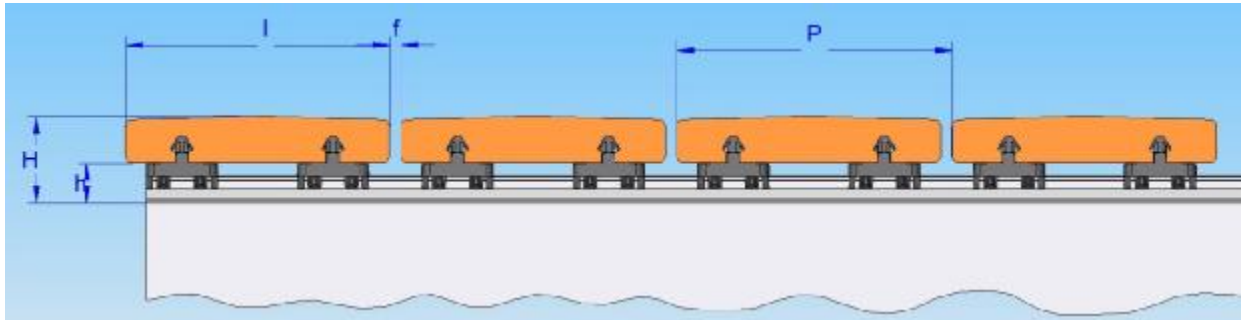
sezione trasversale dei listoni in legno fissati su sottostruttura in alluminio KIT 40 ad altezza fissa
